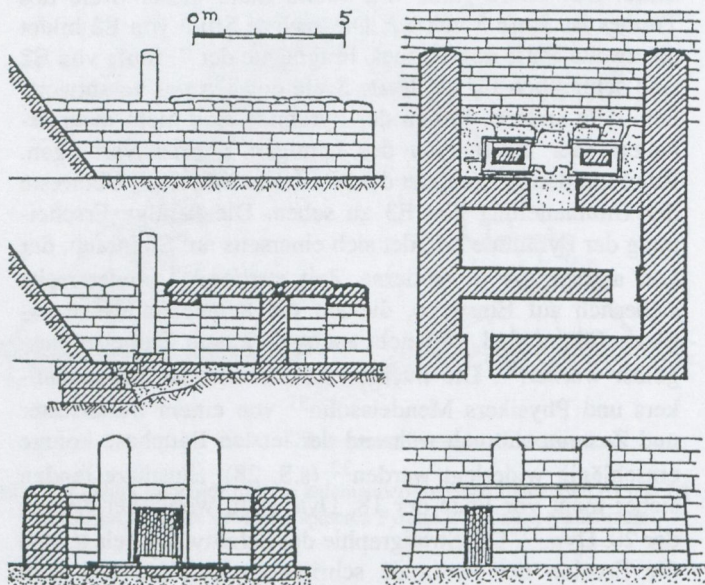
Plan, Fassadenansicht und Schnitt durch das Stelenheiligtum an der Ostseite der Pyramide, nach Lauer
